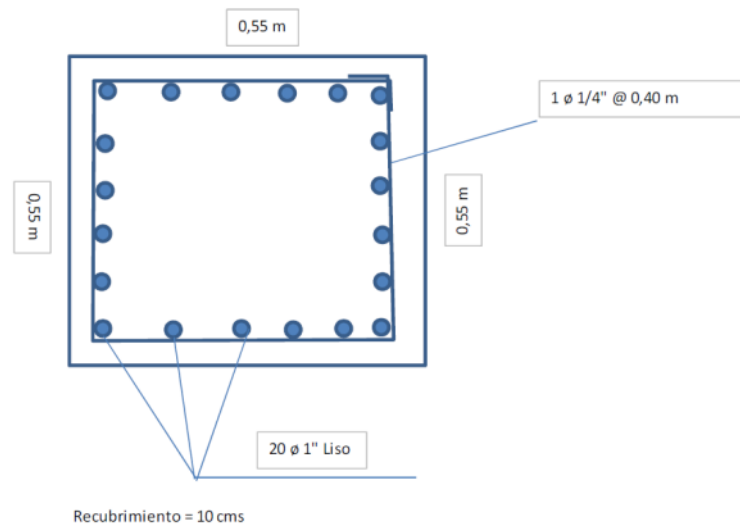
Sección Transversal Típica Columnas del primer piso. Edificio EPM
